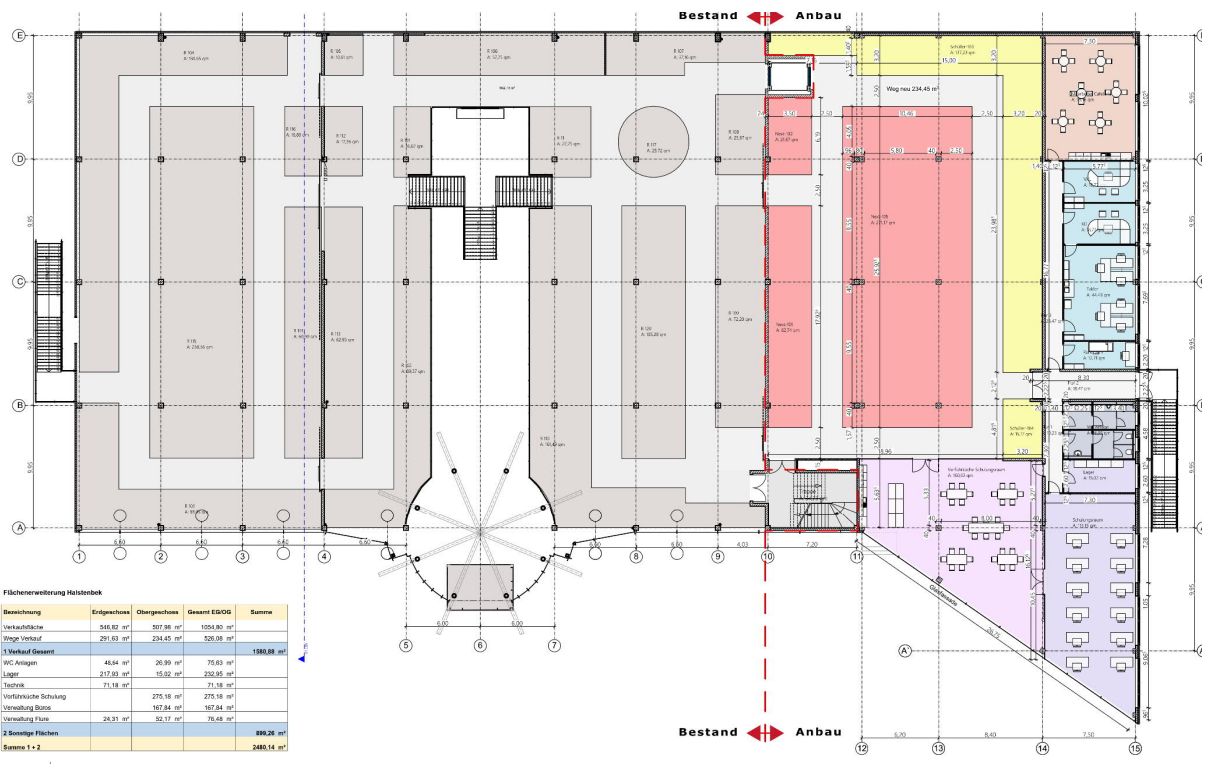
Grundriss 1.OG mit Erweiterungsanbau in Farbe
